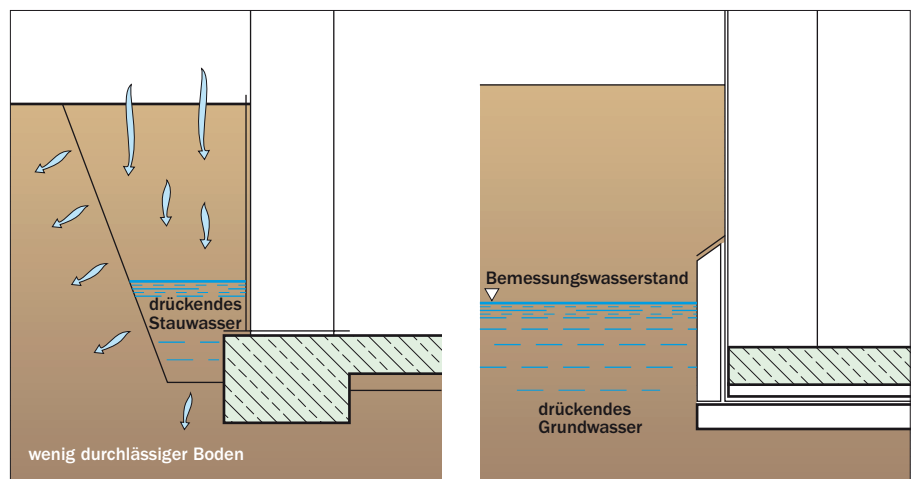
Situationen mit Druckwasserbeanspruchung der erdberührten Bauteile: Baugrund gering wasserundurchlässig (links); Gebäudesohle liegt unterhalb des Bemessungswasserstandes (rechts).
